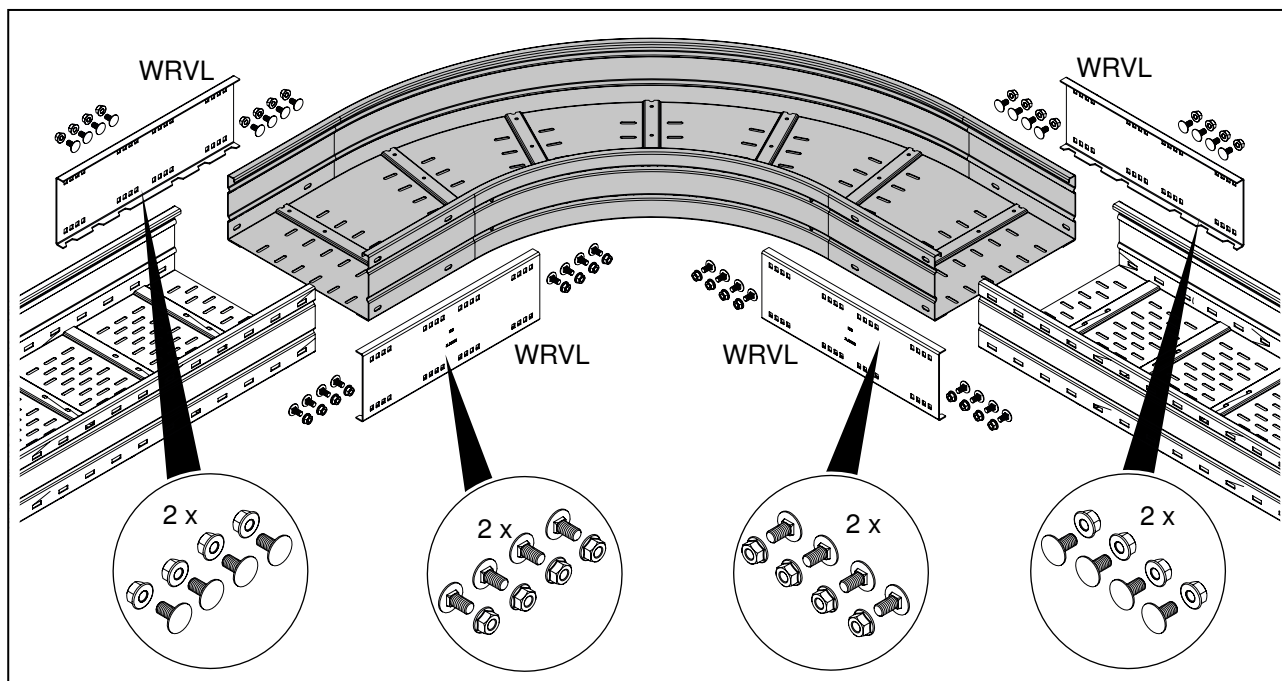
Элементы для монтажа угловой секции 90° с высотой боковой стенки 160 мм
